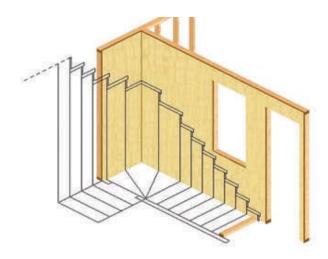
27: Trazado de la proyección horizontal y vertical de huellas y contrahuellas de la escalera.
